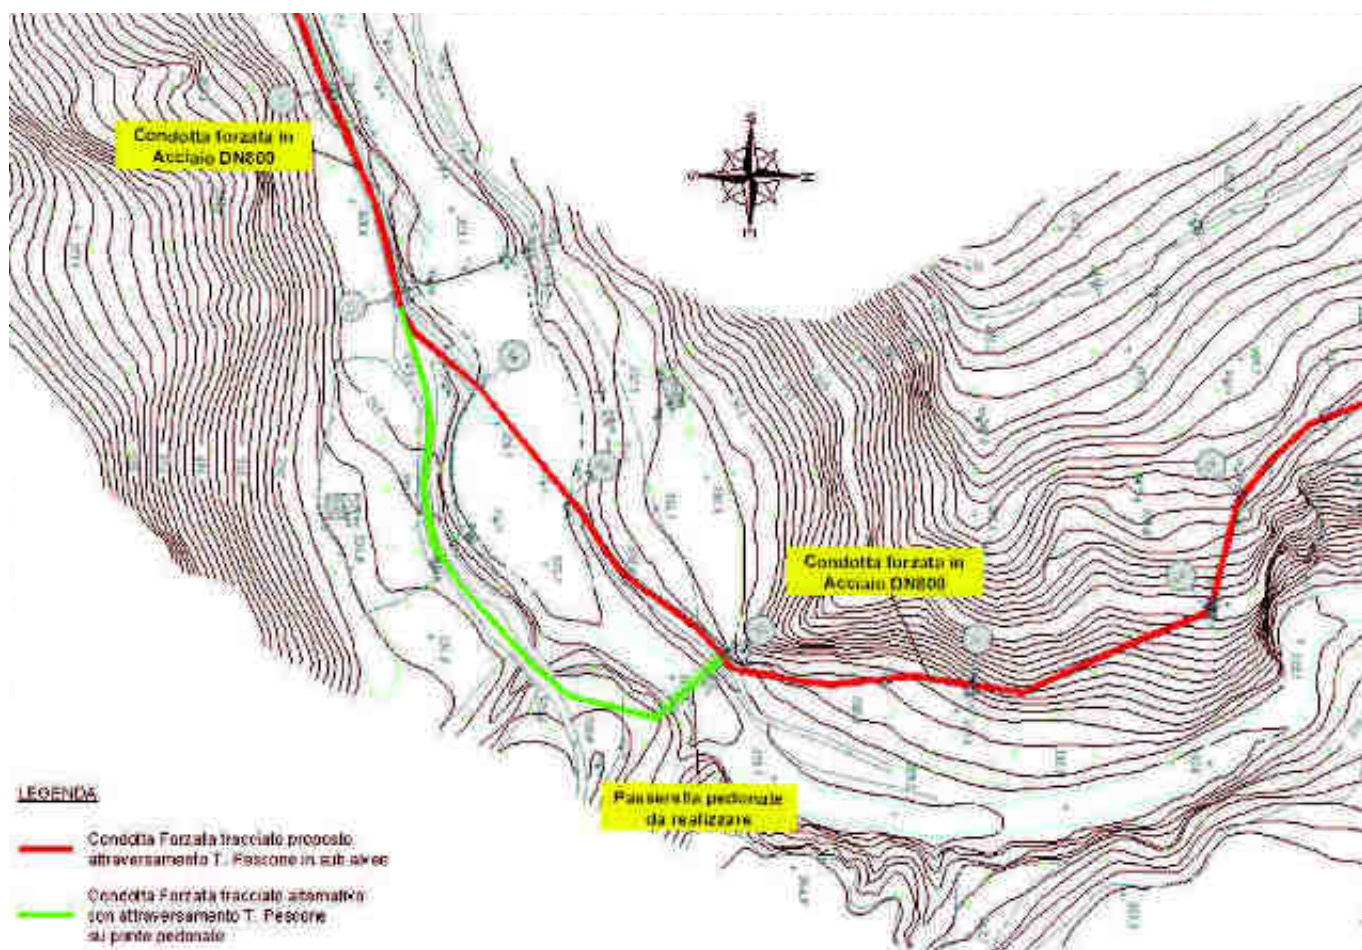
tracciato alternativo - planimetria percorso alternativo con passerella pedonale sul torrente Pescone
